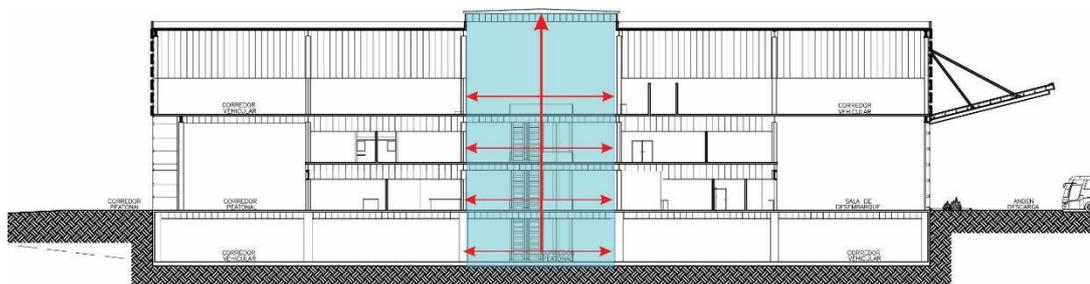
Volumen arquitectónico del Terminal Terrestre
